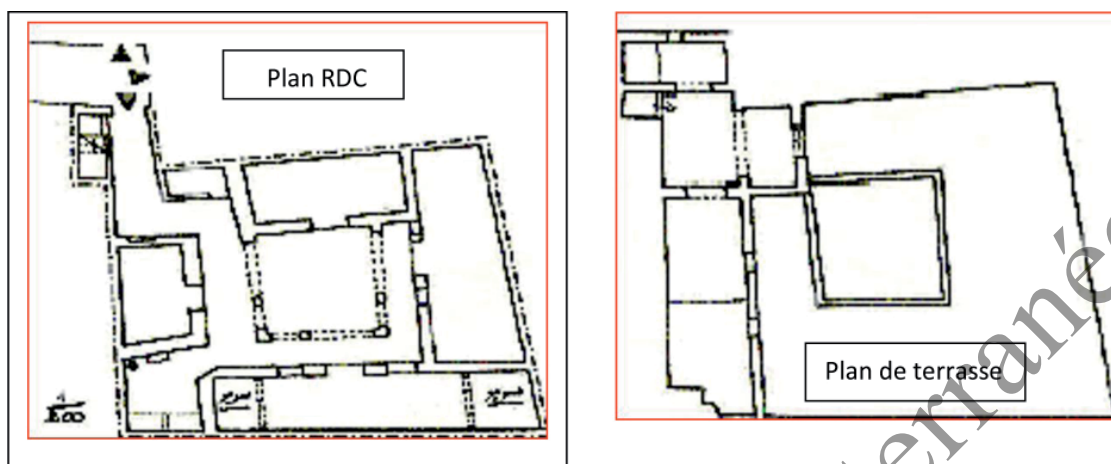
Plan d'une maison de type zianide celle du n°12 de derb Selsla. Plans du rez de chaussée et des terrasses.
